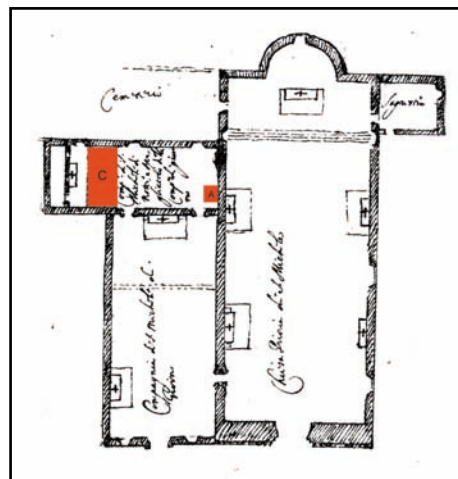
Volterra: planimetria con indicazione dell'area dell'intervento.
